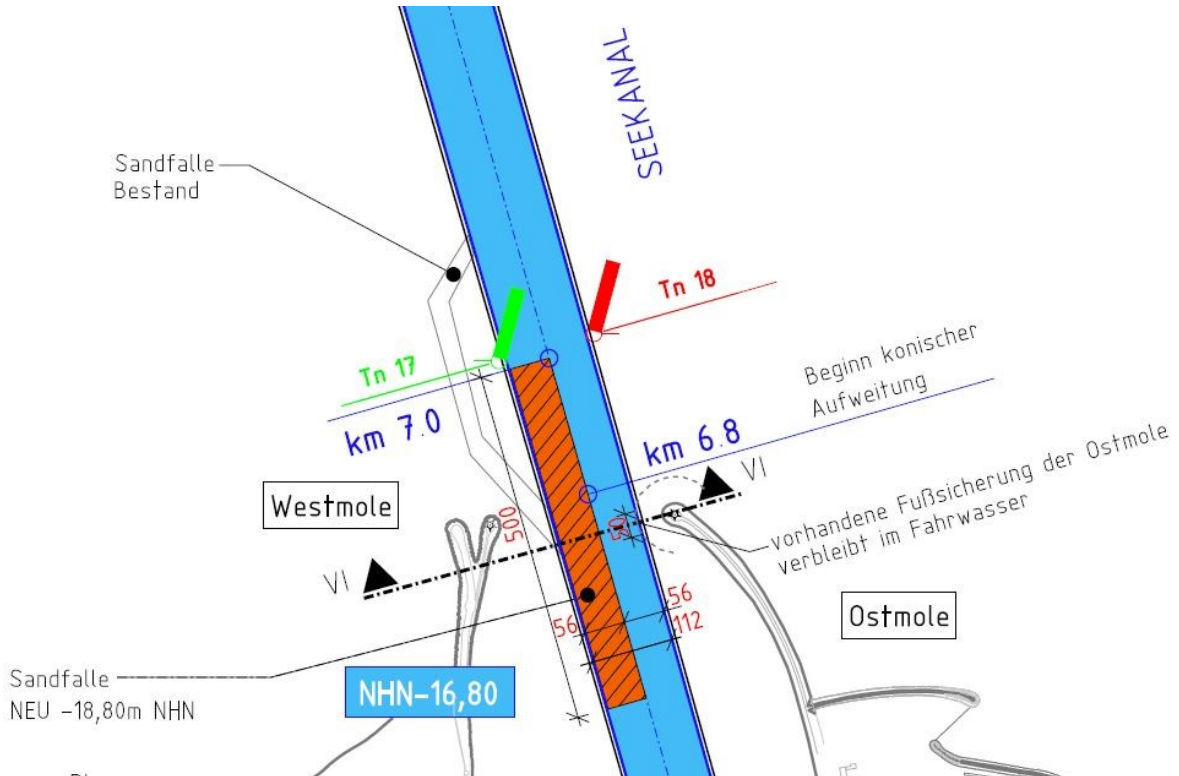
Ausschnitt aus 02\_1\_3.2 Lageplan Bestand und Planung km 5,0 bis 8,0
